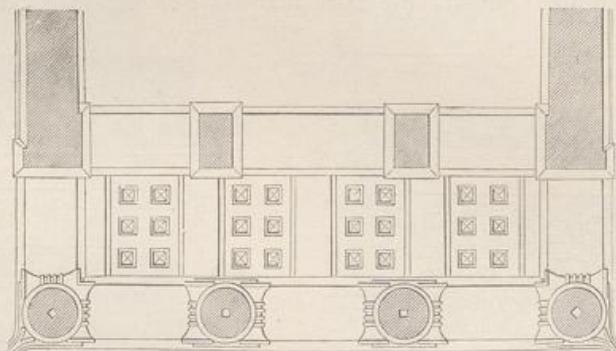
Niketempel zu Athen (Grundriss der Vorhalle, Decke).
